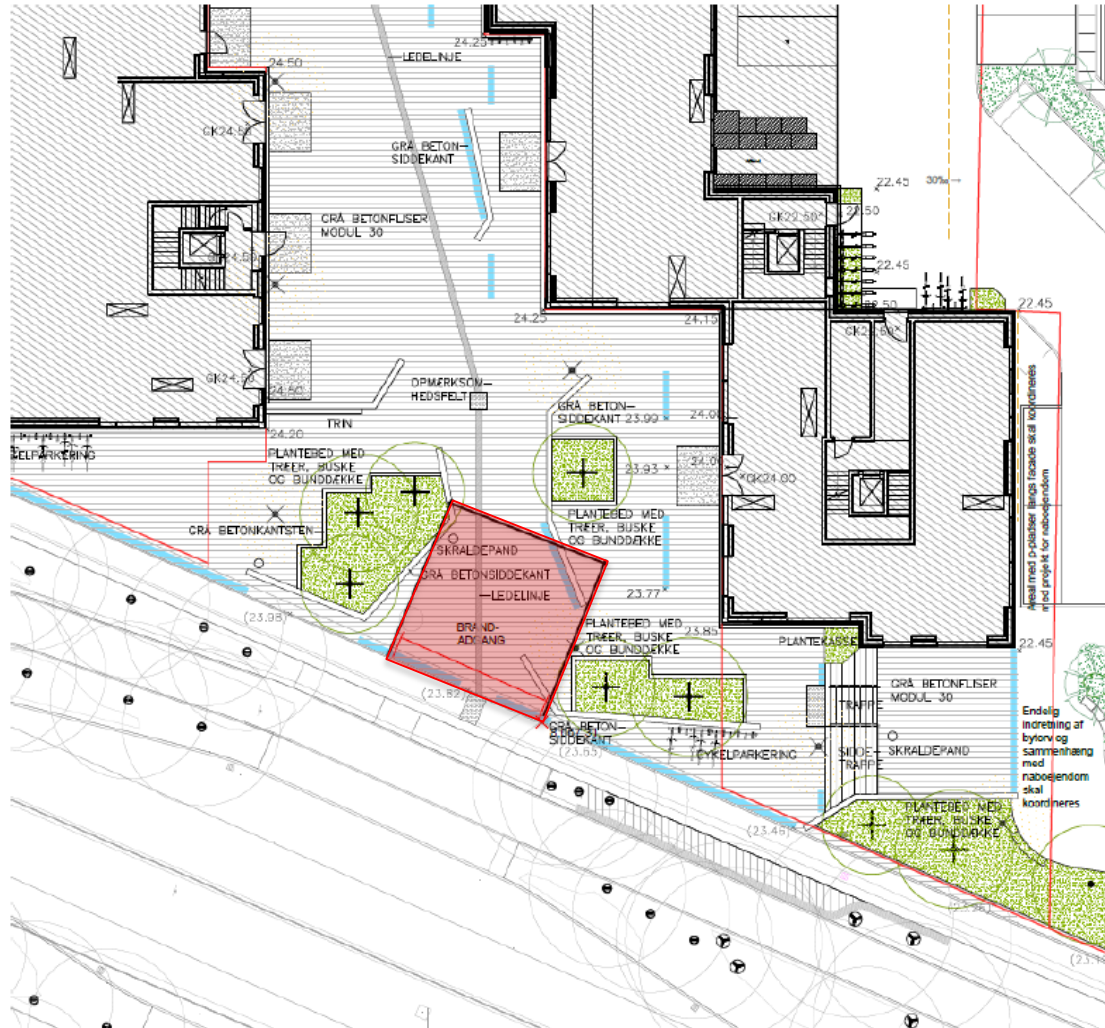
Illustreret rampe- og trappeforløb og elevator ved 5 meter fjernet.
